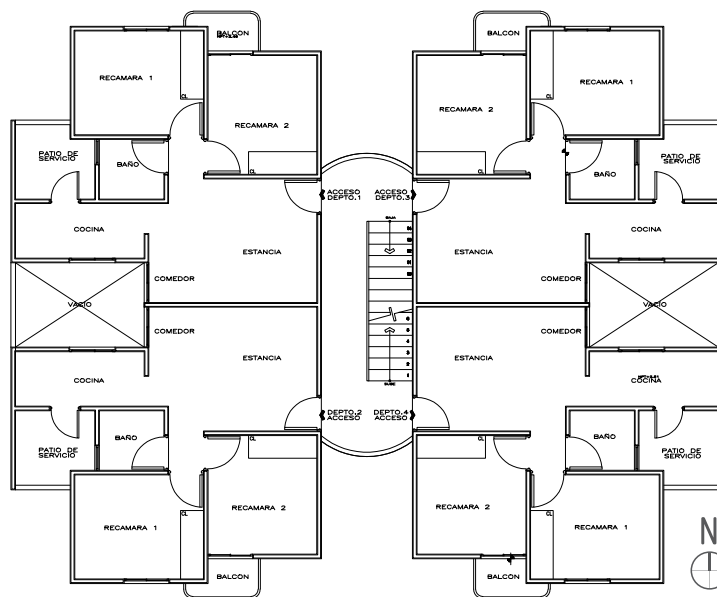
Planta arquitectónica de edificación Vertical y maqueta en 3D, sin escala
